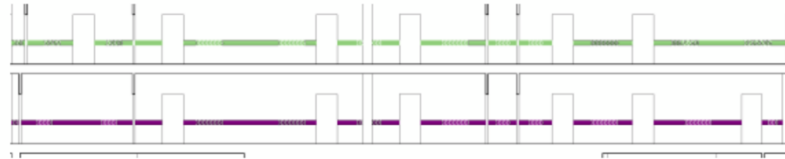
Solución llevada a cabo en el edificio. Líneas guía a la altura del peto, cambian de color según la planta donde se disponen. Ayudan al usuario para dirigirse a un determinado lugar.
